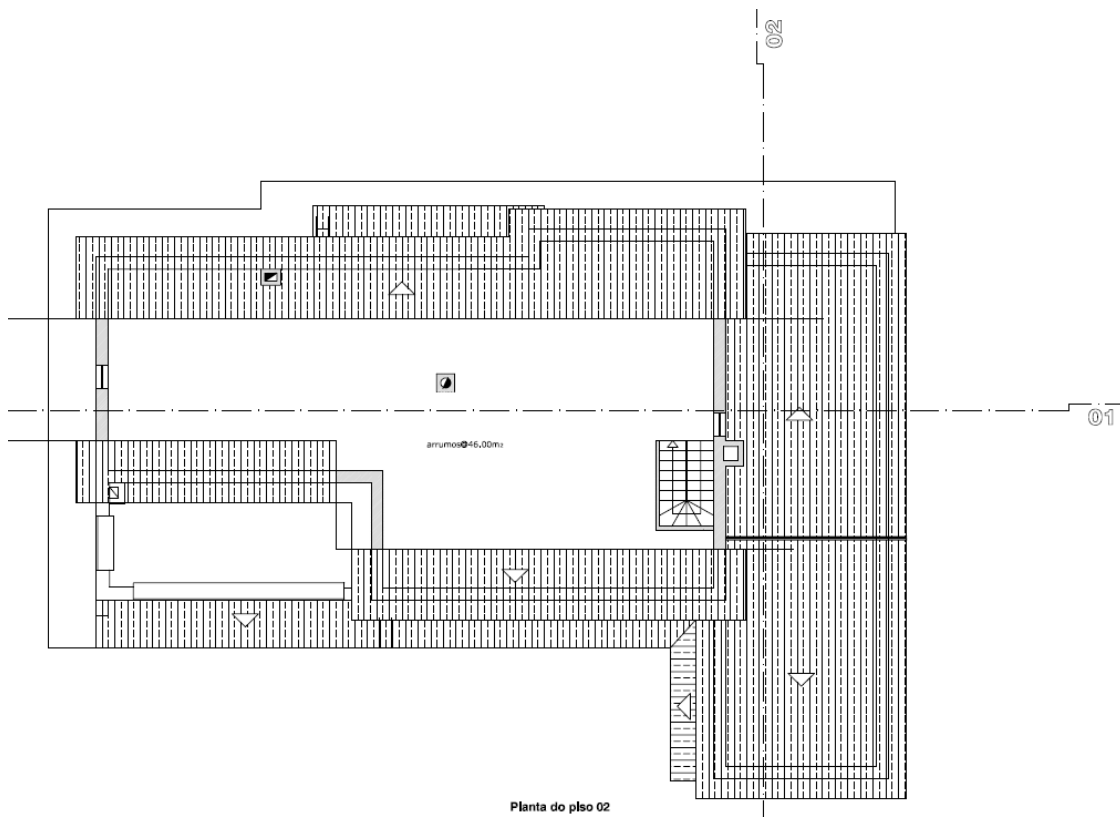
Planta do piso 2 do edifício de habitação em fase de projeto.
